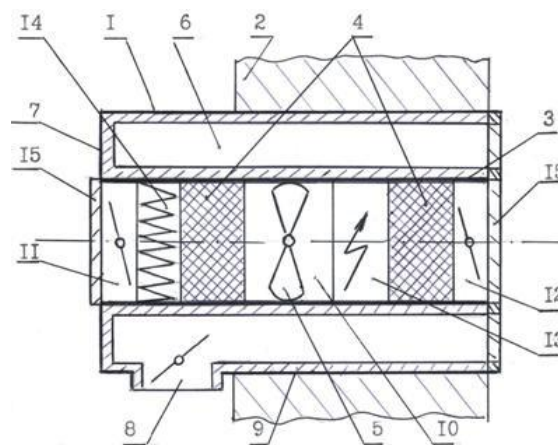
Приточно-вытяжная установка (патент №127875)
